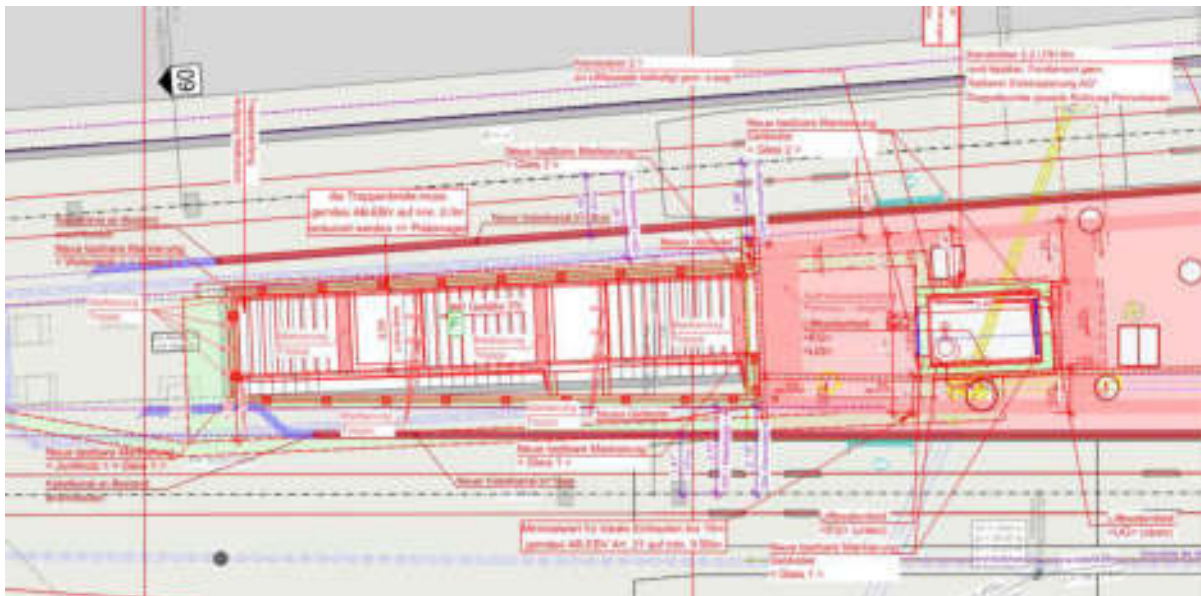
Planausschnitt Zugang Welschloh (21)
